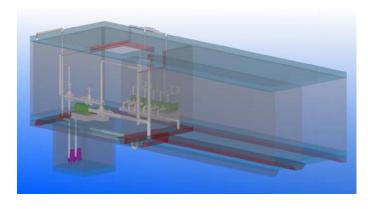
Modelo de estructuras contiene los pases para las instalaciones (Tekla)
